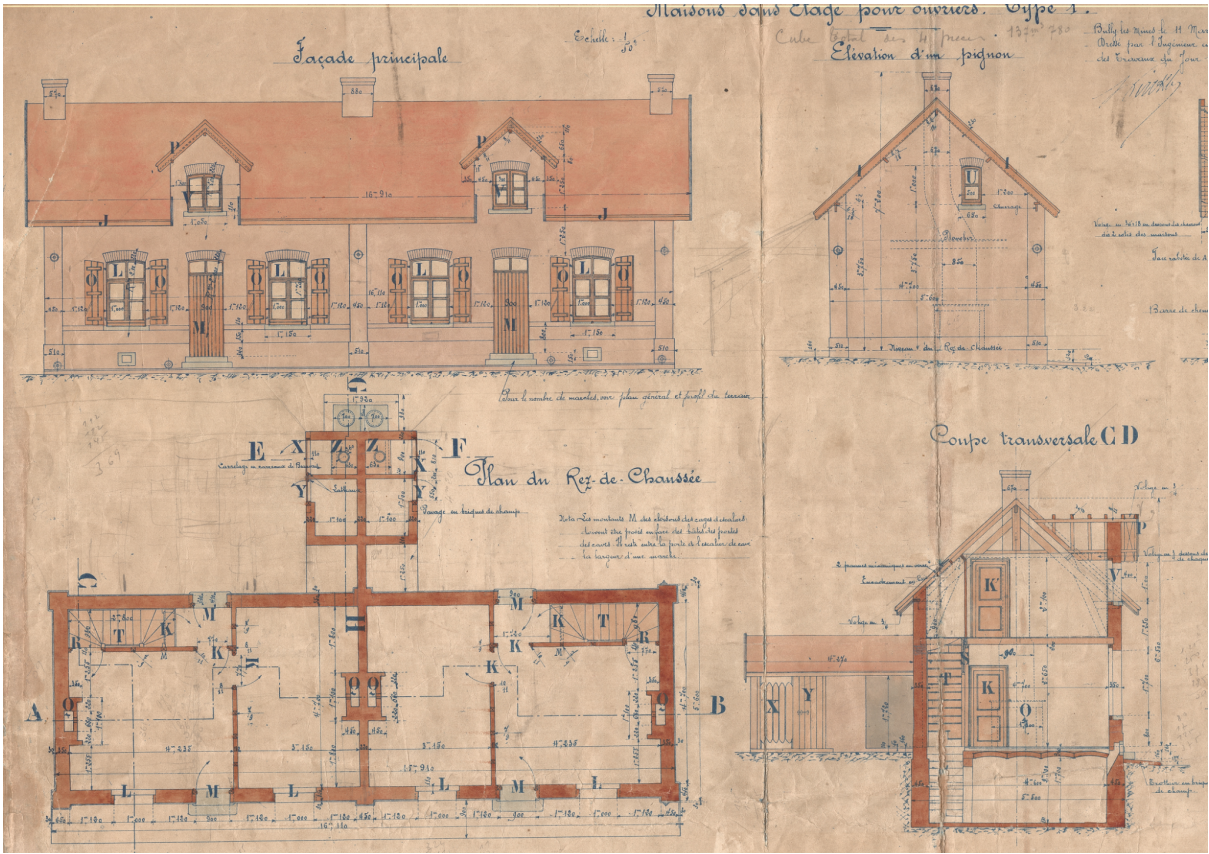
et 8 : Plan logements cité pavillonnaire /source Archives Maisons&Cités
